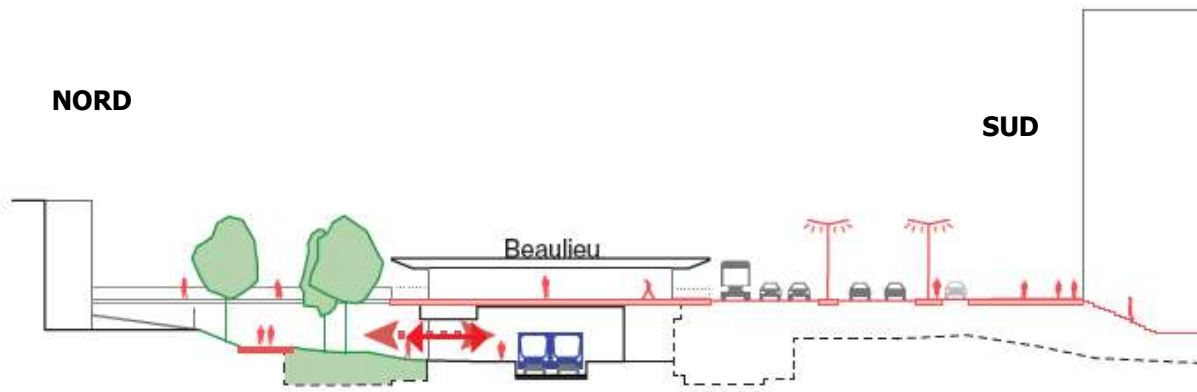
Profil de la place Beaulieu du site Beaulieu (ORG², 2018)
